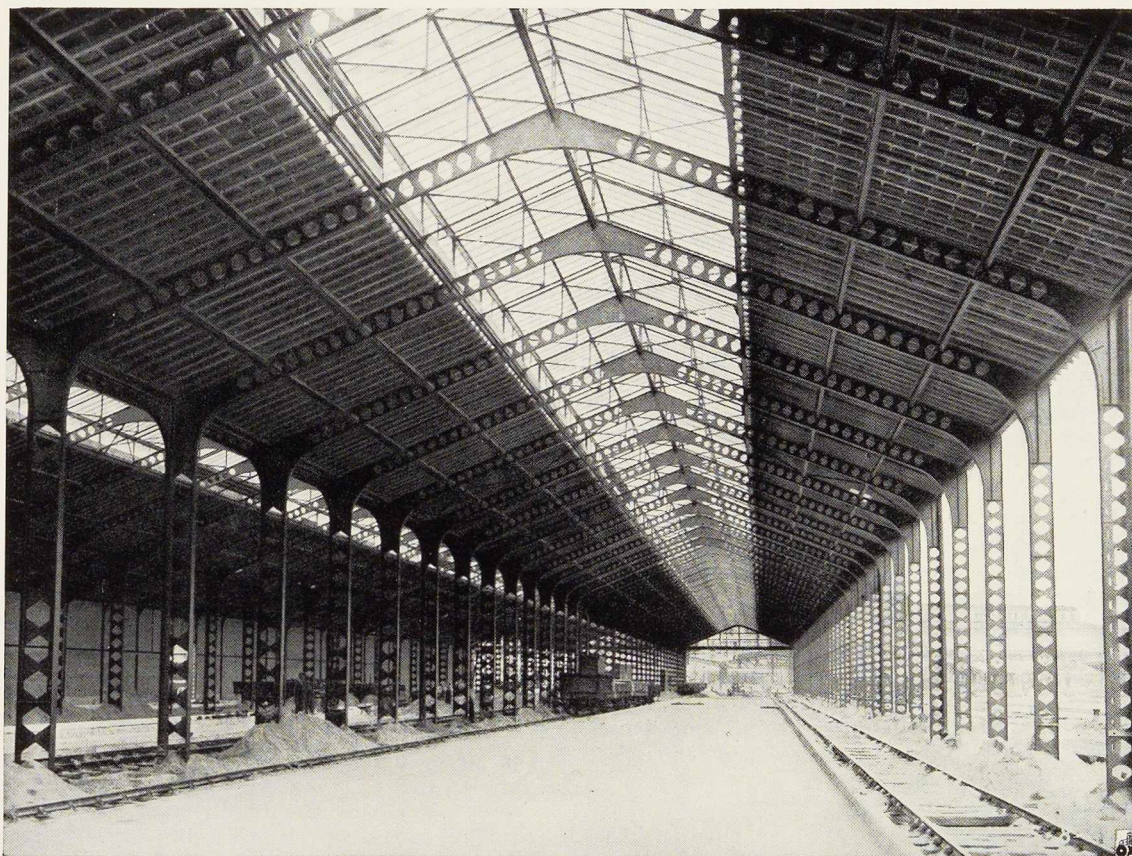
Halle C après achèvement, on aperçoit à gauche les halles A et B et dans le fond l'ossature de la cour couverte N.
